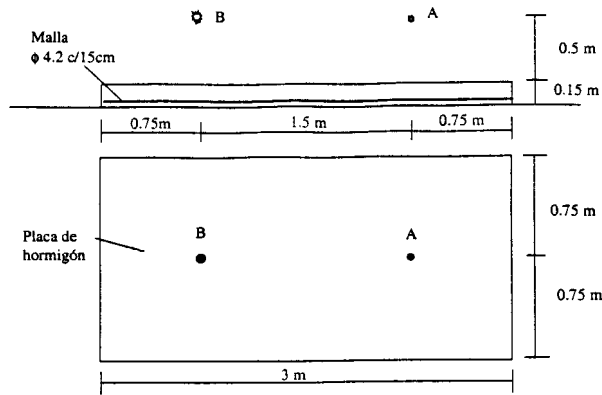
Esquema de la placa de hormigón y de las cargas aplicadas
